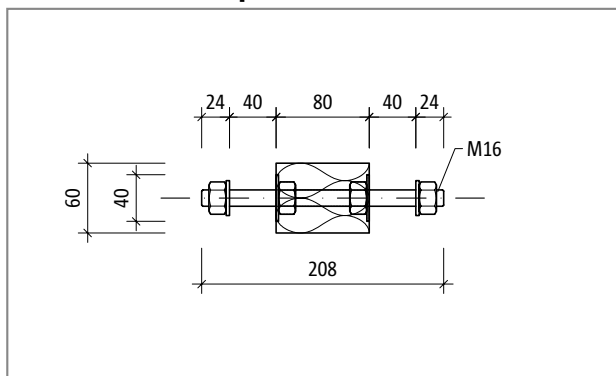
Schöck Isokorb® T tipo S-N-D16: sezione dell'elemento
